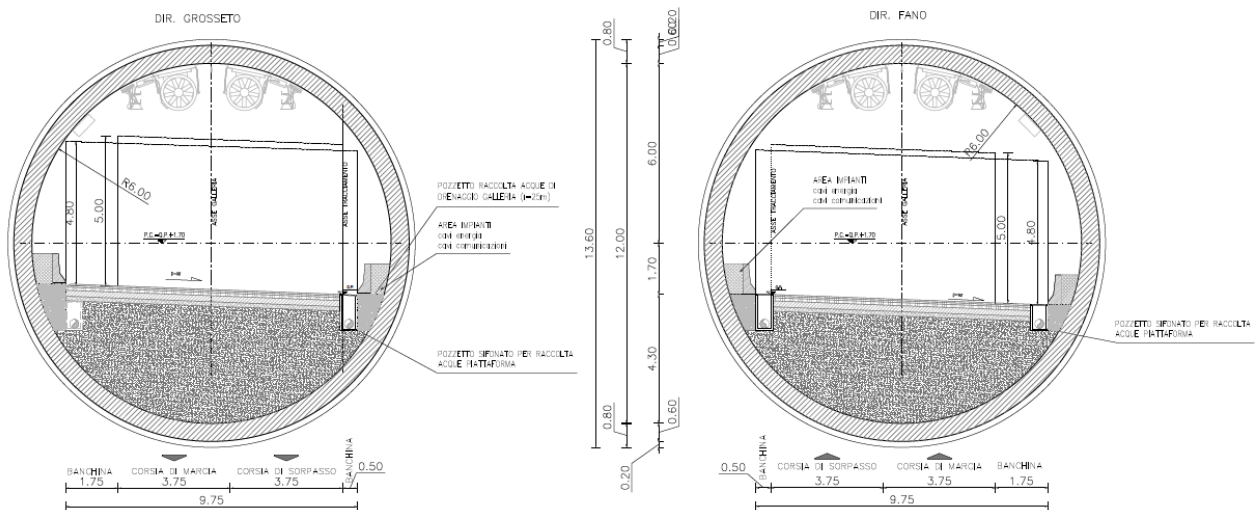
Sezione tipo galleria Citerna prevista in PD
